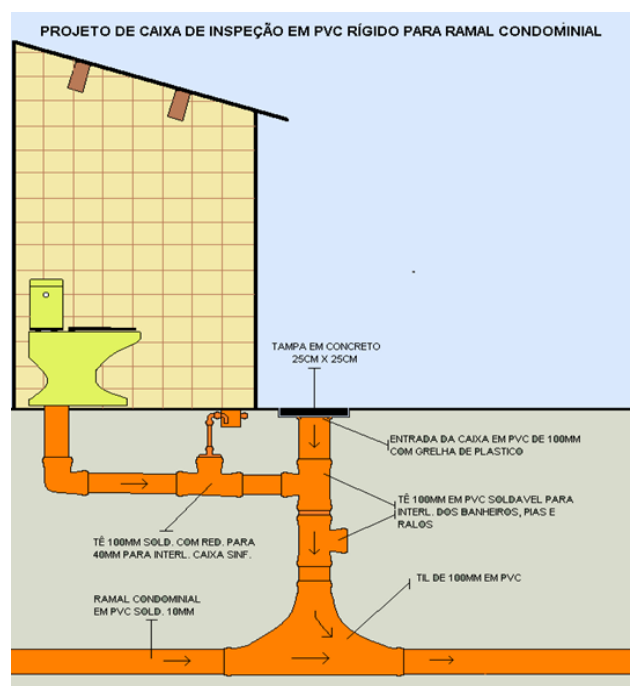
Situação das ligações de esgoto condominiais com a implantação do dispositivo
